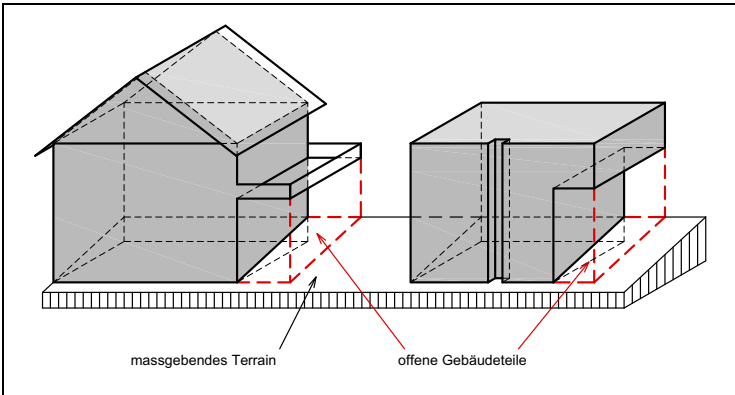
Anrechenbare Grundstücksfläche (§ 259 PBG)
